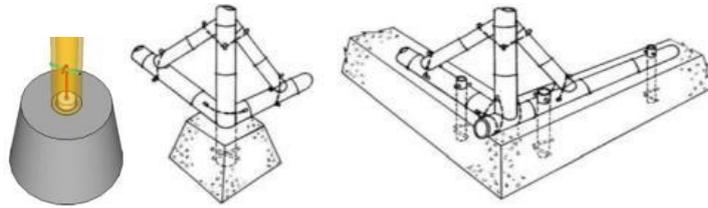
Penerapan bambu pada konstruksi atap
